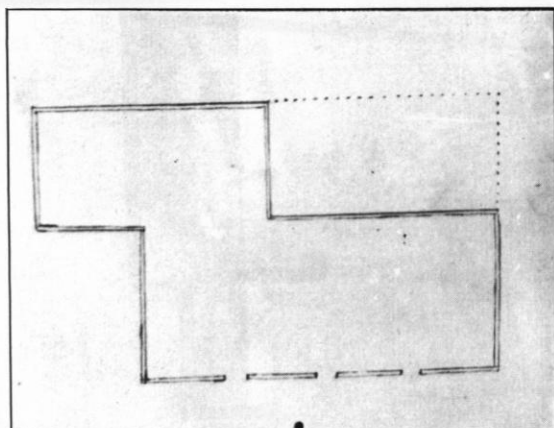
Plano planta y alzado de c/ Orilla del Río esquina Puerto de Camaroneros, Pedro de San Martín, abril 1782. (A.A.P.S., Sec. Histórica, leg. 378).
